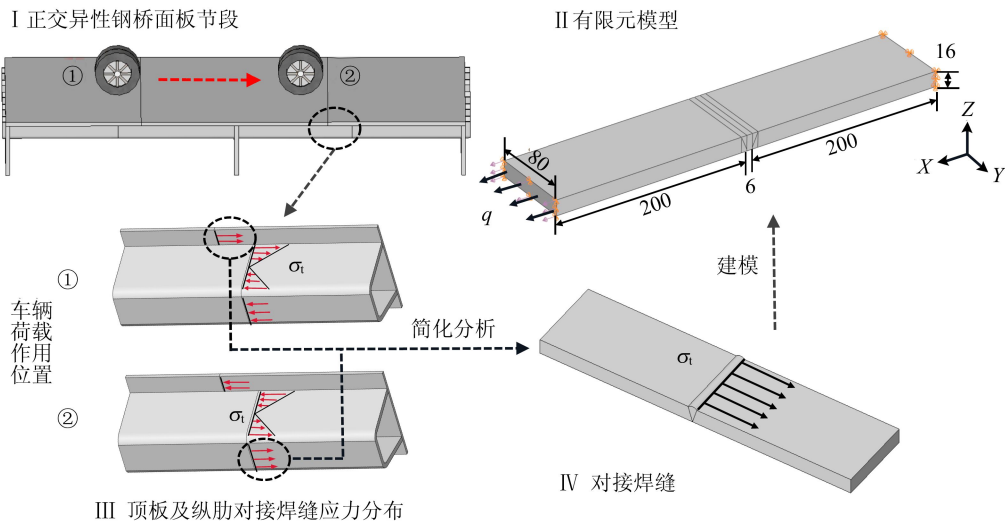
纵肋对接焊缝疲劳细节受力与等效
